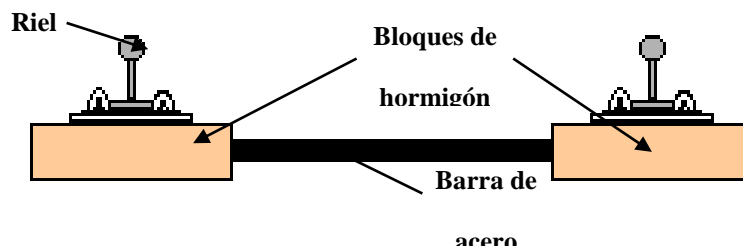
Durmiente mixto de acero y hormigón.²⁰
